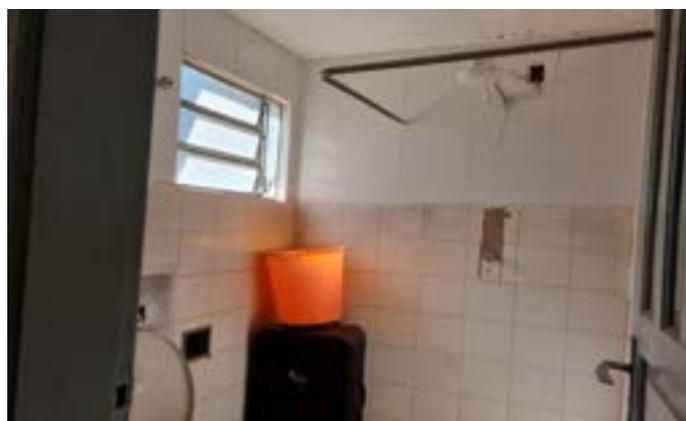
FOTO DO BANHEIRO DA ÁREA DE SERVIÇO
